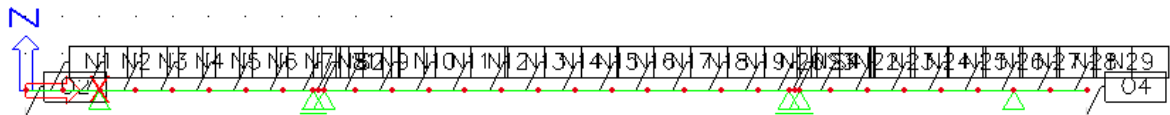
2. Fáze výstavby – betonáž opěry, čas 15. den
